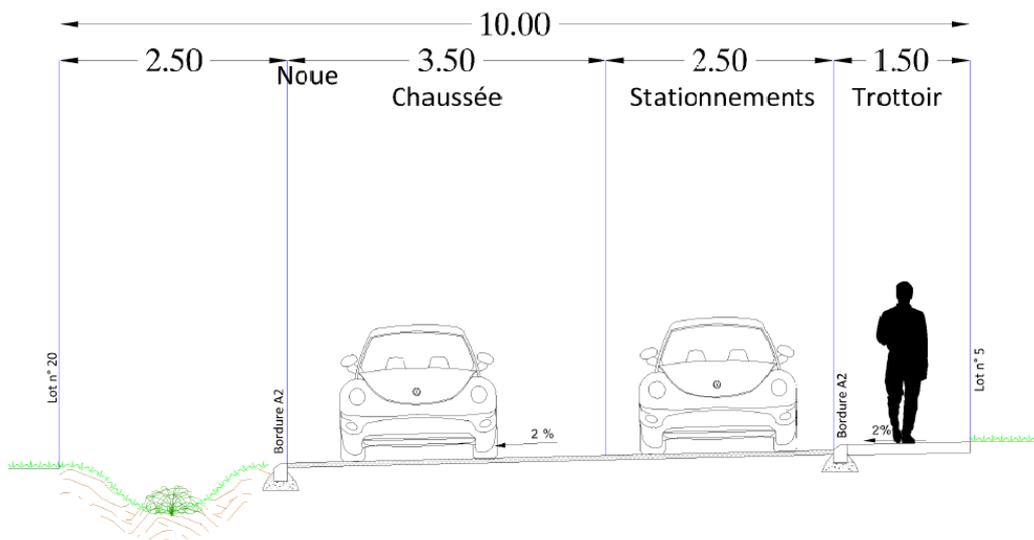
Coupe de la voirie secondaire avec stationnement latéral
